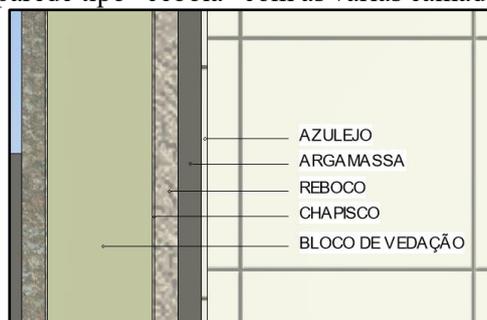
Detalhamento das camadas de parede tipo “cebola”.
